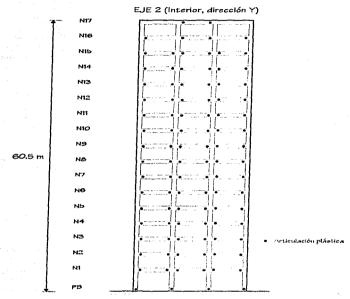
Distribución global de articulaciones plásticas del eje 2 (inclástico) de la estructura de 17 niveles discriada en la zona II, acclerograma SCT-EW-85
